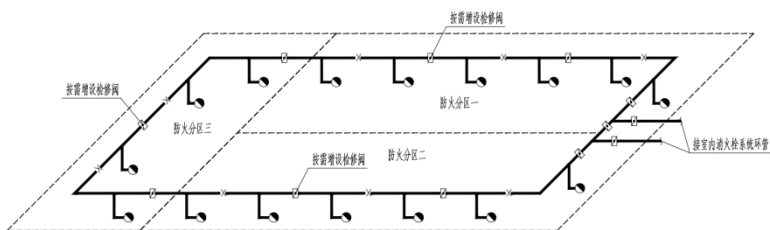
室内消火栓系统水平环网布置一示意图
